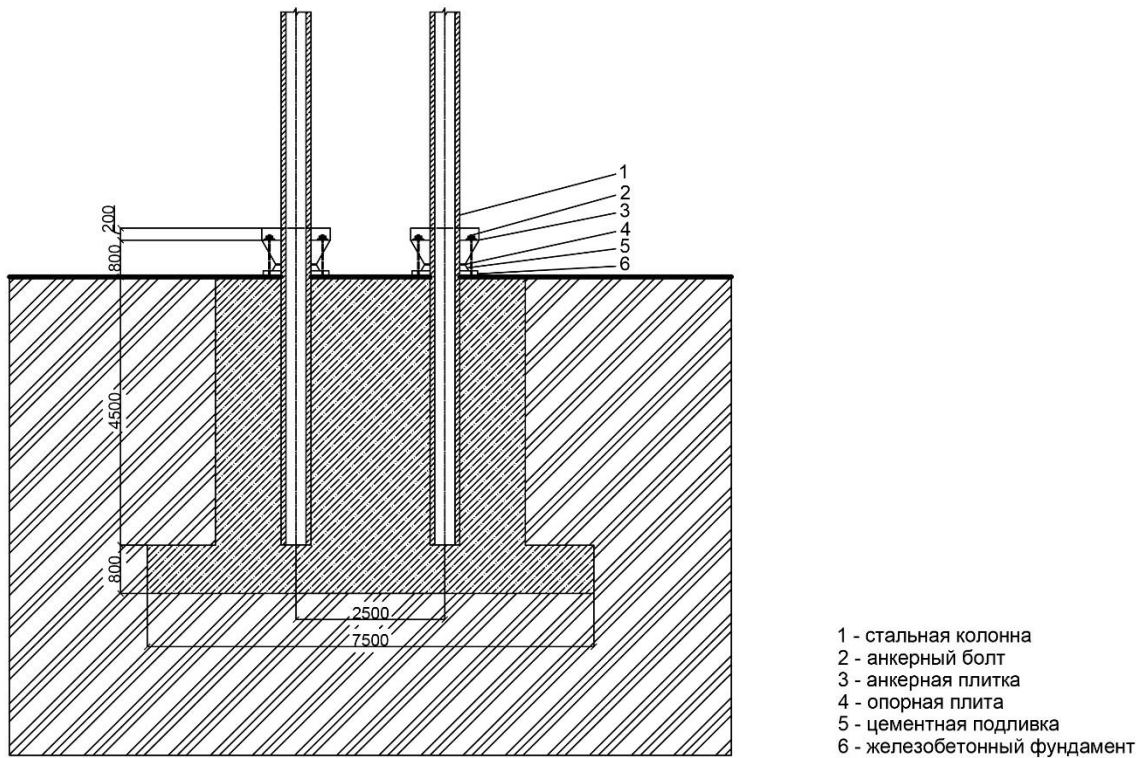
Узел монолитного фундамента под колоннами [15]
